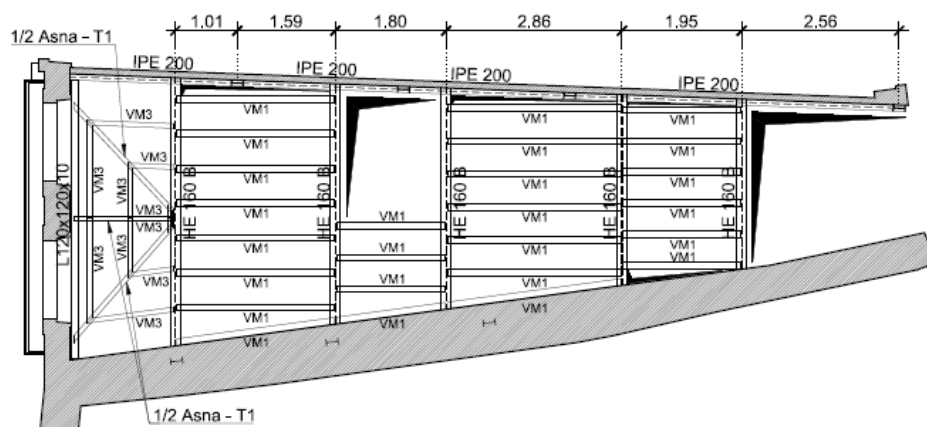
Planta estrutural do piso 4 (Projeto de Estruturas)
